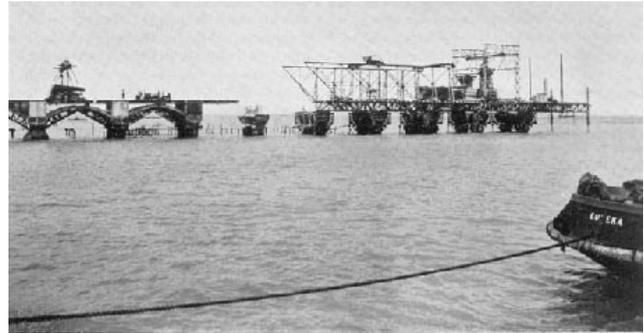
Desfasamiento entre las dos estructuras metálicas empleadas (Christensen, 1954)
